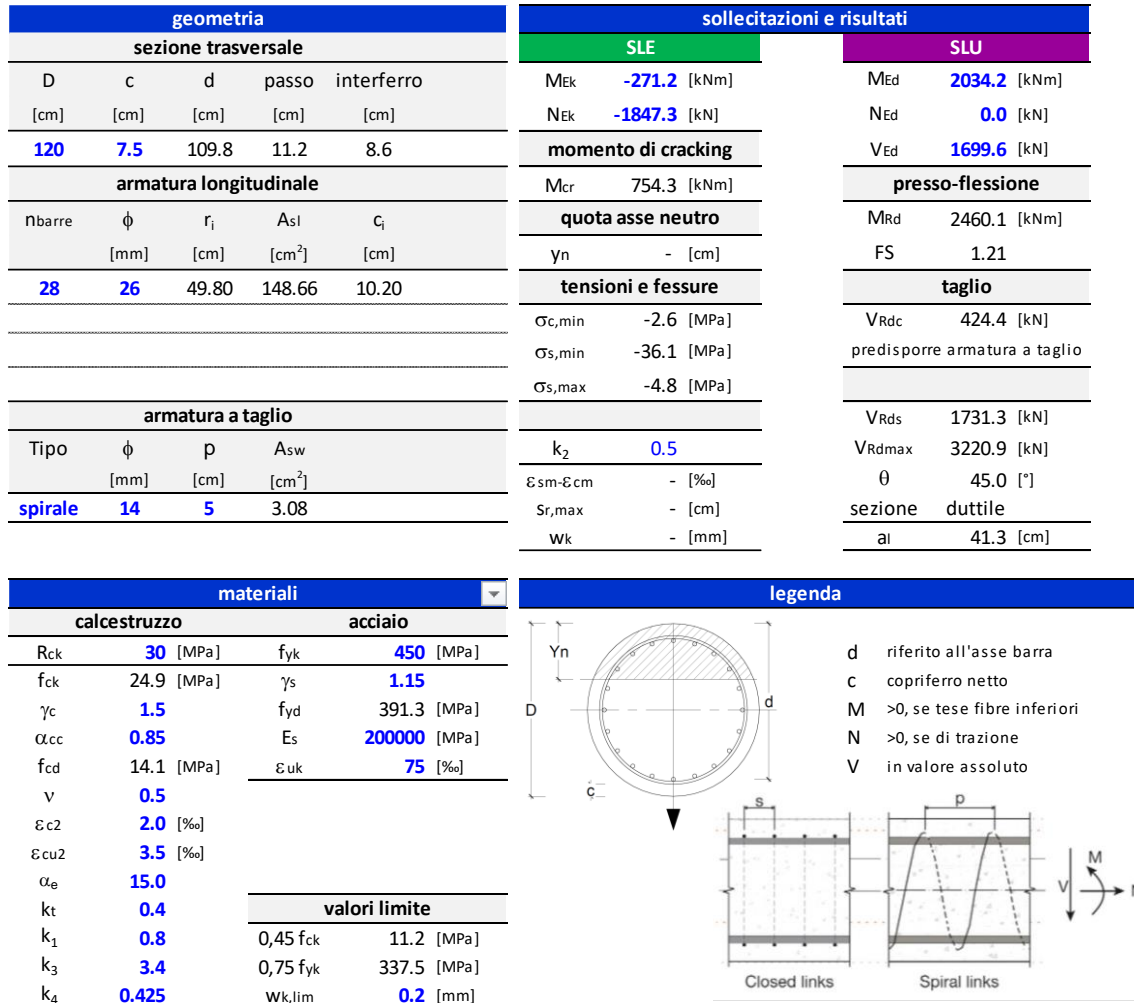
Verifiche allo SLU ed allo SLE di tipo STR pali di fondazione.
